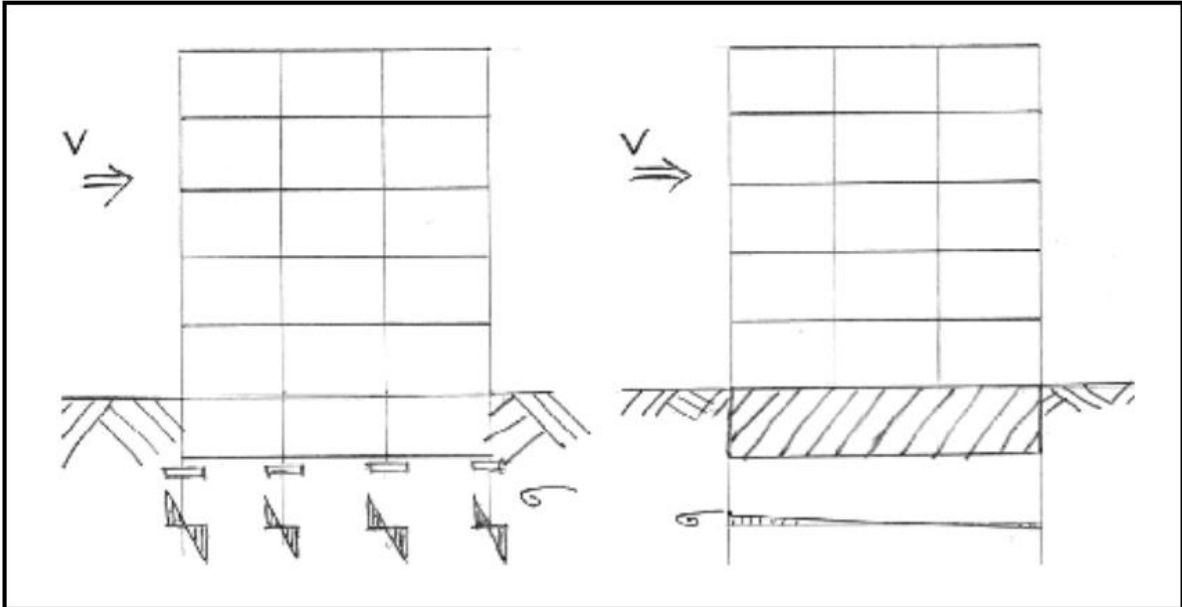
Un radier général raidi par les murs de sous-sol base réduit les contraintes à la fondation [3].
